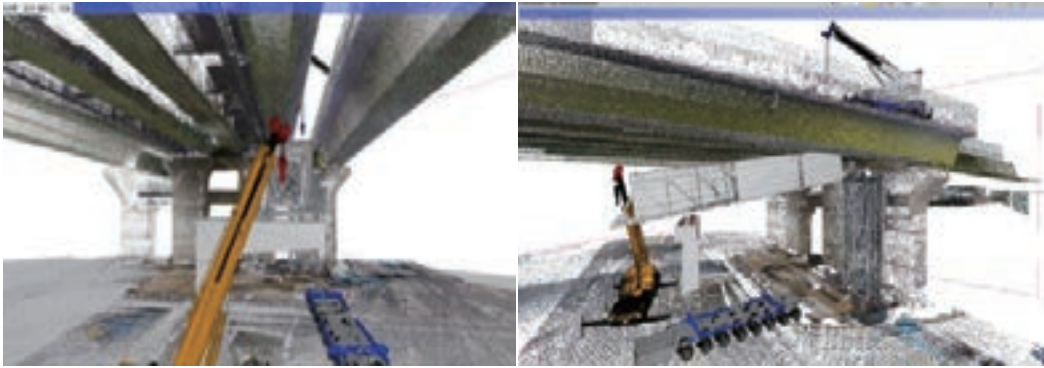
現地取得した点群モデルと 3D 施工モデルの合成
